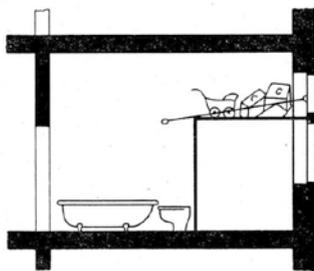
Unzureichende Belüftung und Belichtung eines Badezimmers mit vorgelagerter Mädchenkammer.
